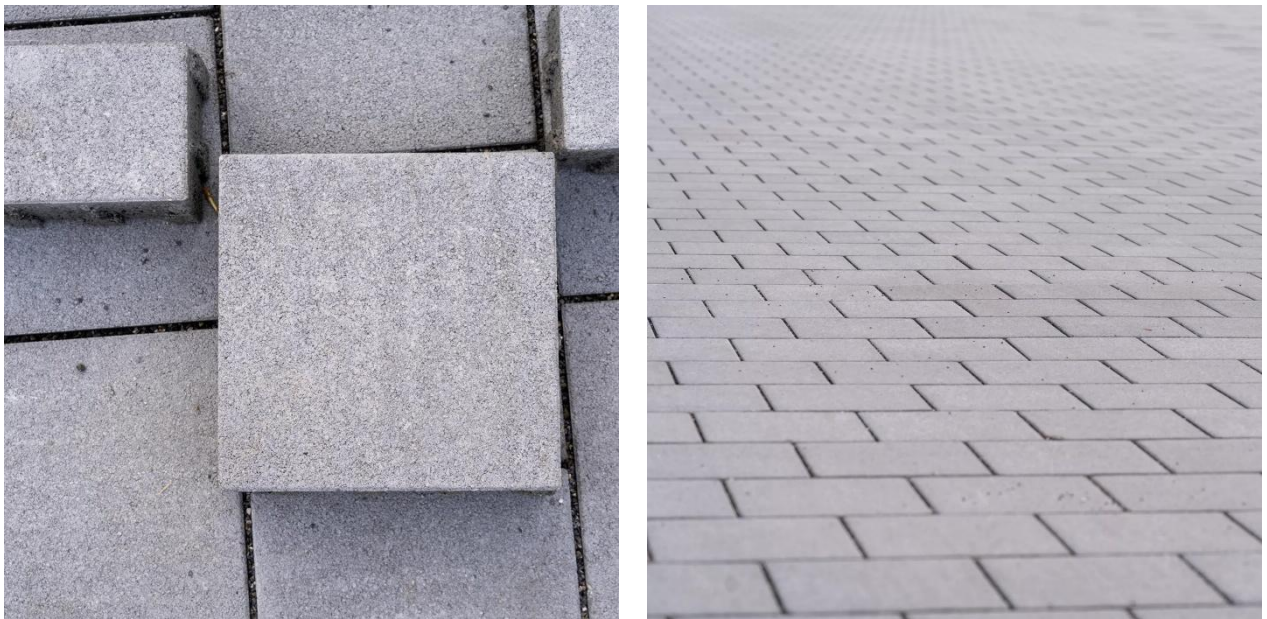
Betonverbundsteine, CreaBeton Clima Stone Drain fein gefast (Quelle: creabeton.ch)
